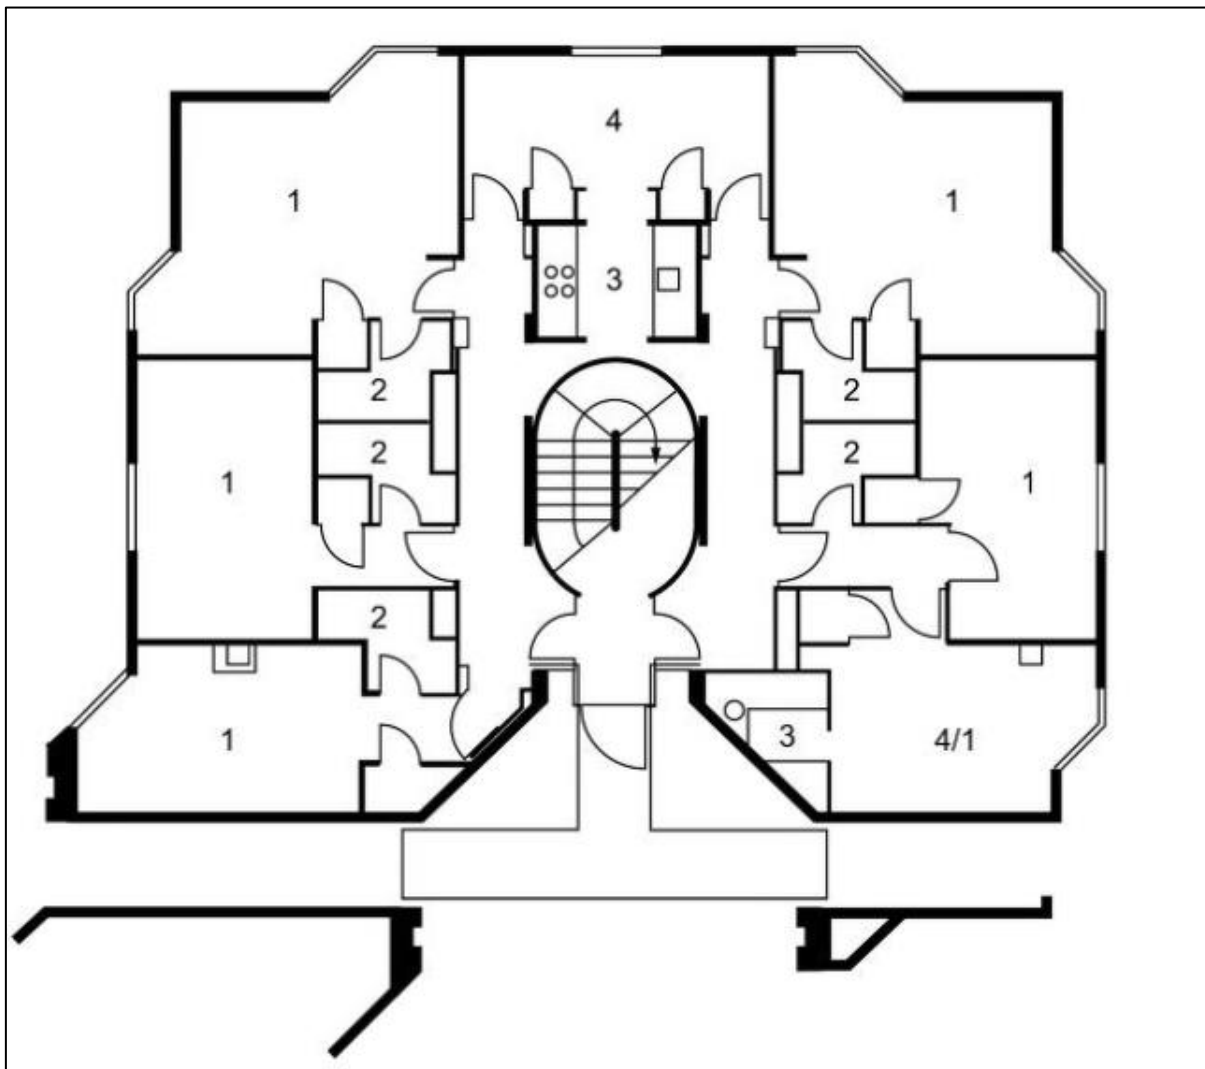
Planta do pavimento térreo com uma escada central de *Balliol College
